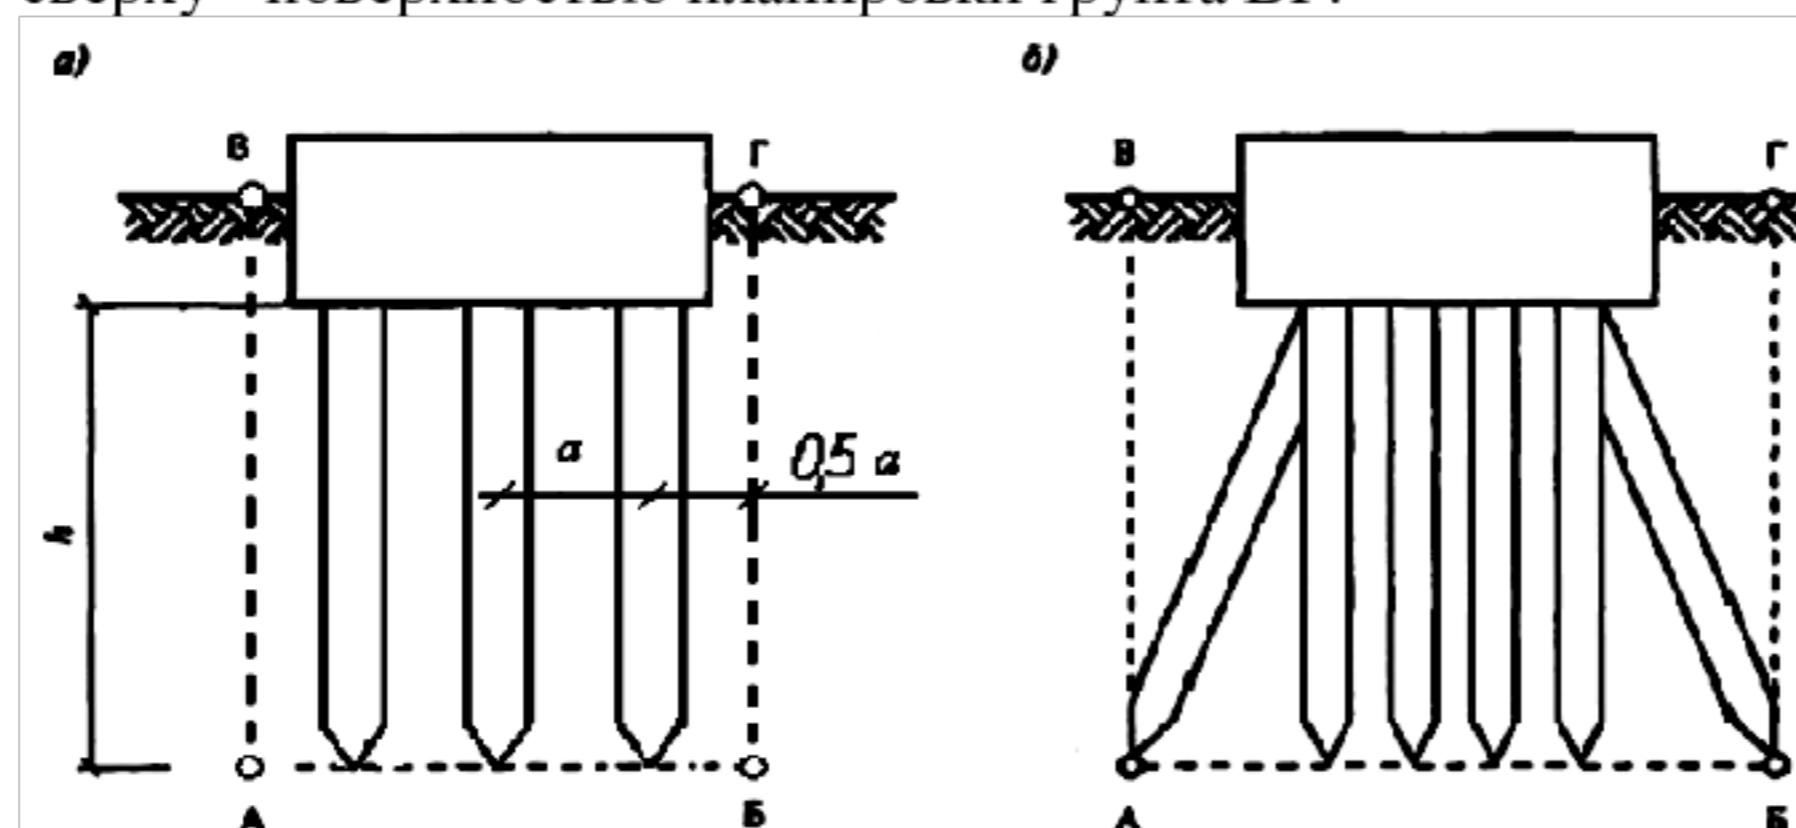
Определение границ условного фундамента при расчете осадки свайных фундаментов
